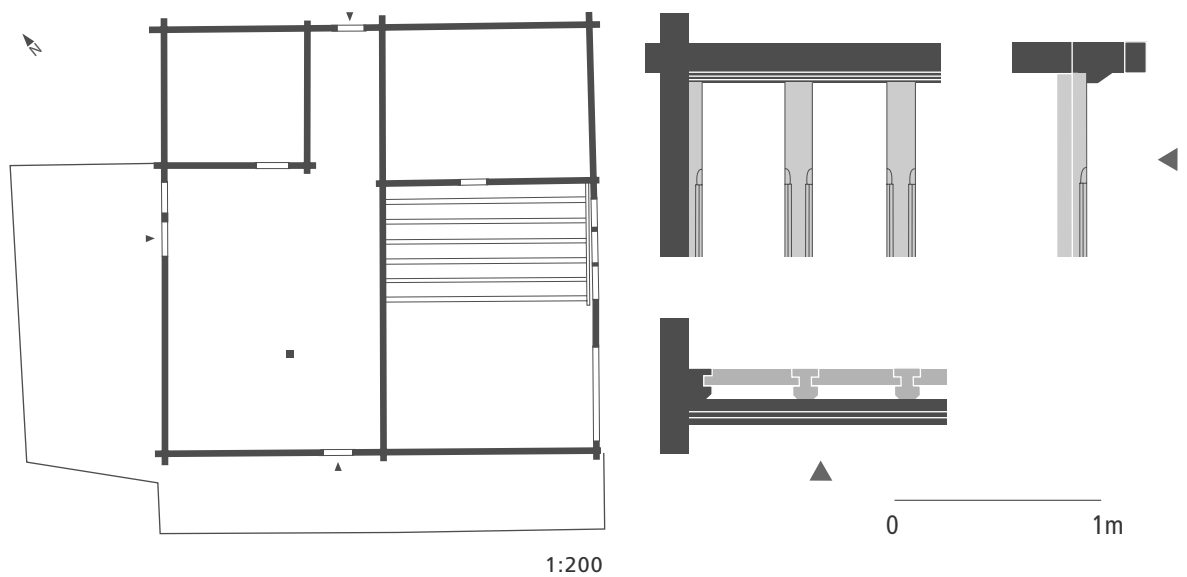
■ Grundriss EG, rekonstruierend ergänzt. Plan D. Hoesli, Kunsthistorisches Institut der Universität Zürich, nach Aufnahme E. Wullschleger, *Atelier d'archéologie médiévale*, 1991.
